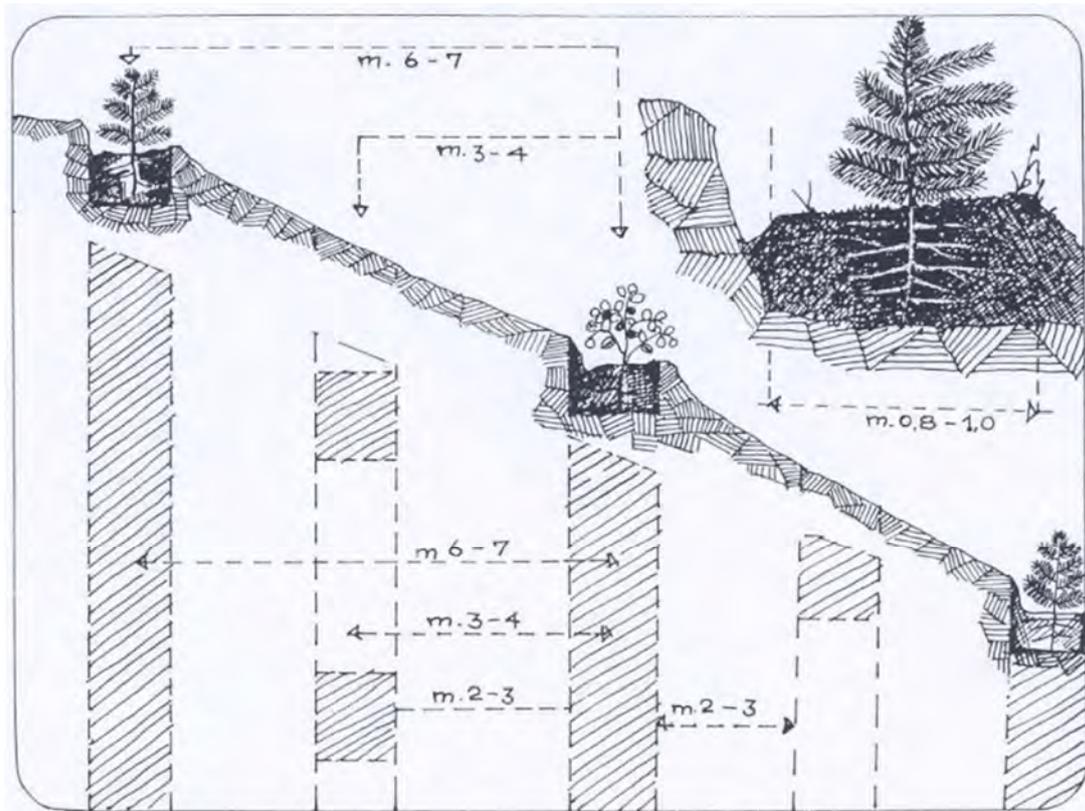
schematizzazione del tipo di lavorazione a trincee e a buche – sezione e prospetto degli interventi in superficie (FONTE: Sardegna Foreste)
